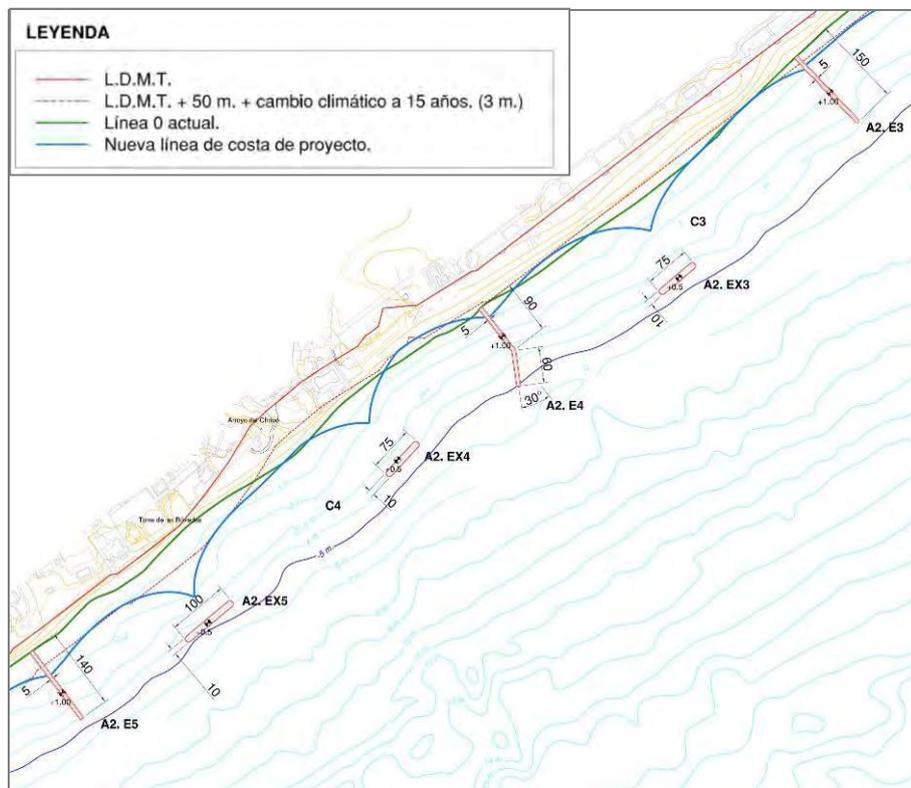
Planta Alternativa 2. Celdas C3-C4.
